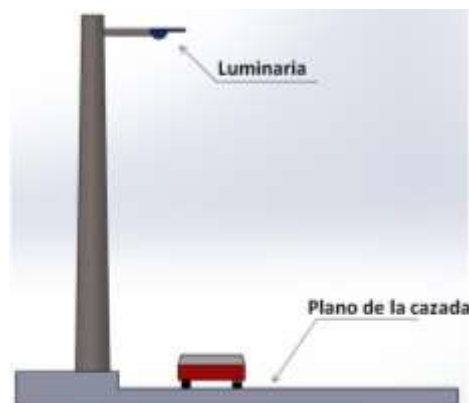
Inclinación de la luminaria respecto al plano de la calzada.
